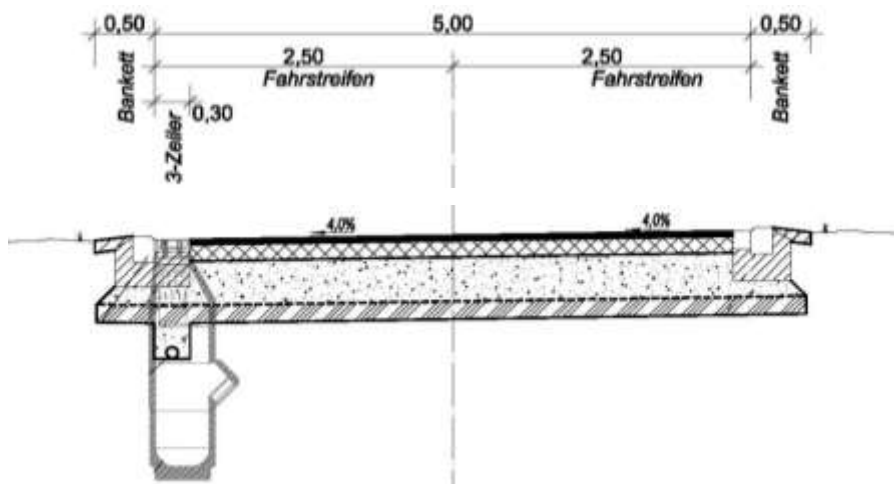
Schnitt Privatstraße aus Verkehrsplanung (Anlage 2 Verfasser: CIC Bauingenieure GmbH Dresden)
